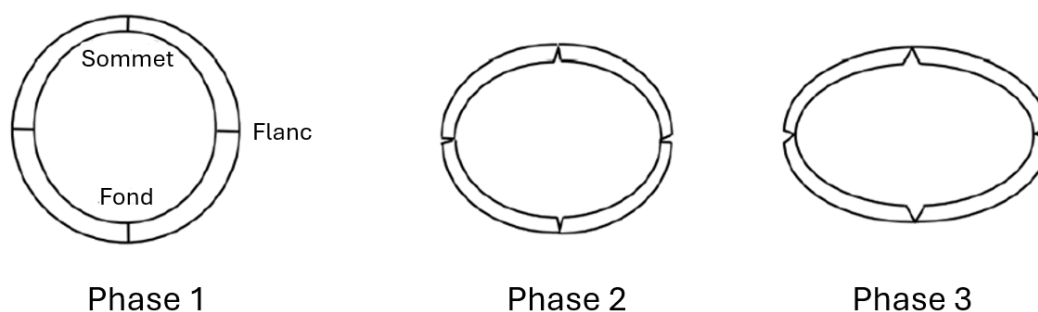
Étapes de fissurations des tuyaux en béton armé lors de leur utilisation (Dangol, 2023)
